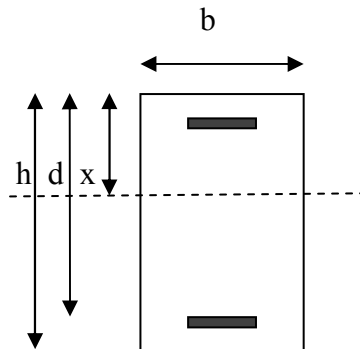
III. 1: Section rectangulaire en béton armé. [9]
